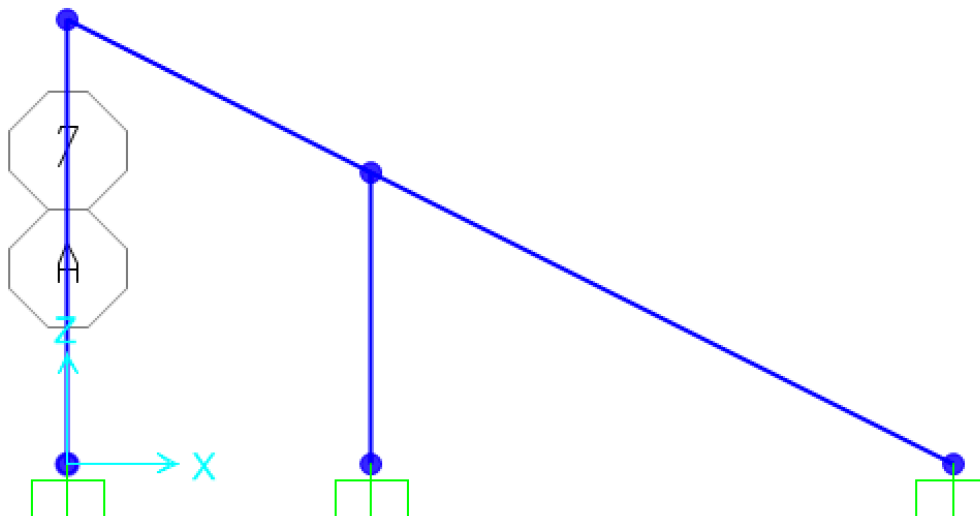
Pórtico transversal tipo de la grada en SAP2000
